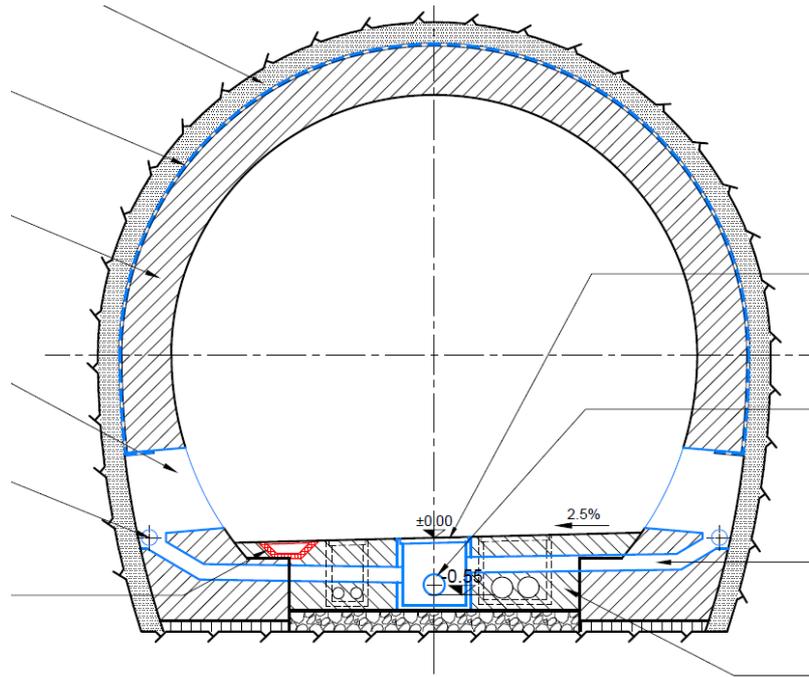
sistema di drenaggio della sezione corrente - galleria di connessione 1 a senso unico di marcia
